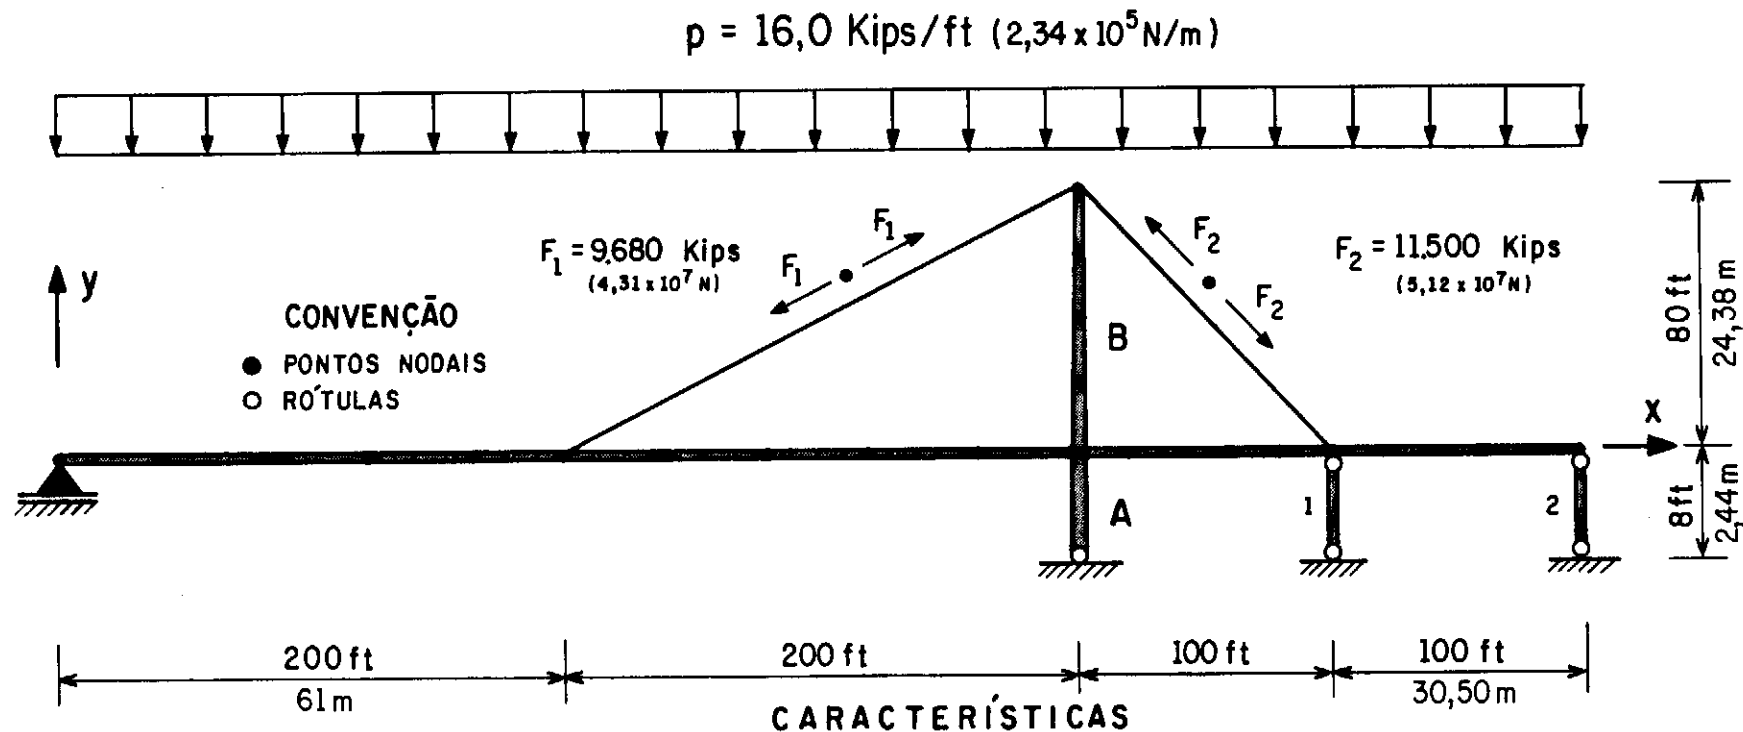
PONTE ESTAIADA METÁLICA: GEOMETRIA, CARREGAMENTO E DISCRETIZAÇÃO.
